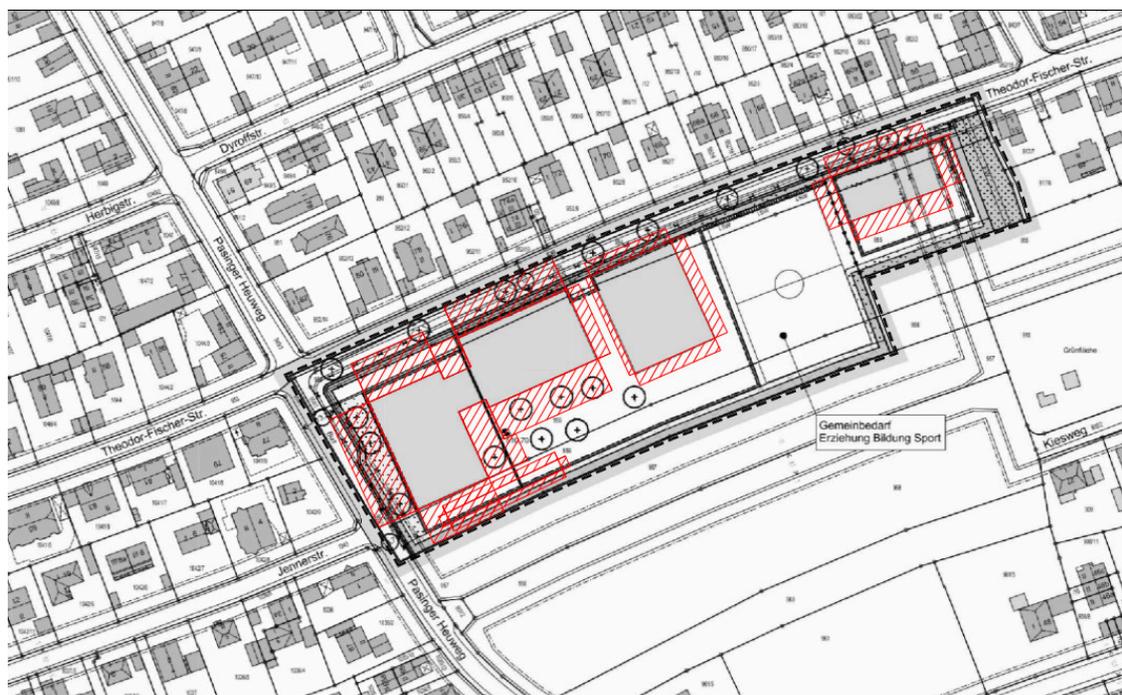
Schemaskizze Abstandsflächen nach der geplanten Baukörperkonfiguration
